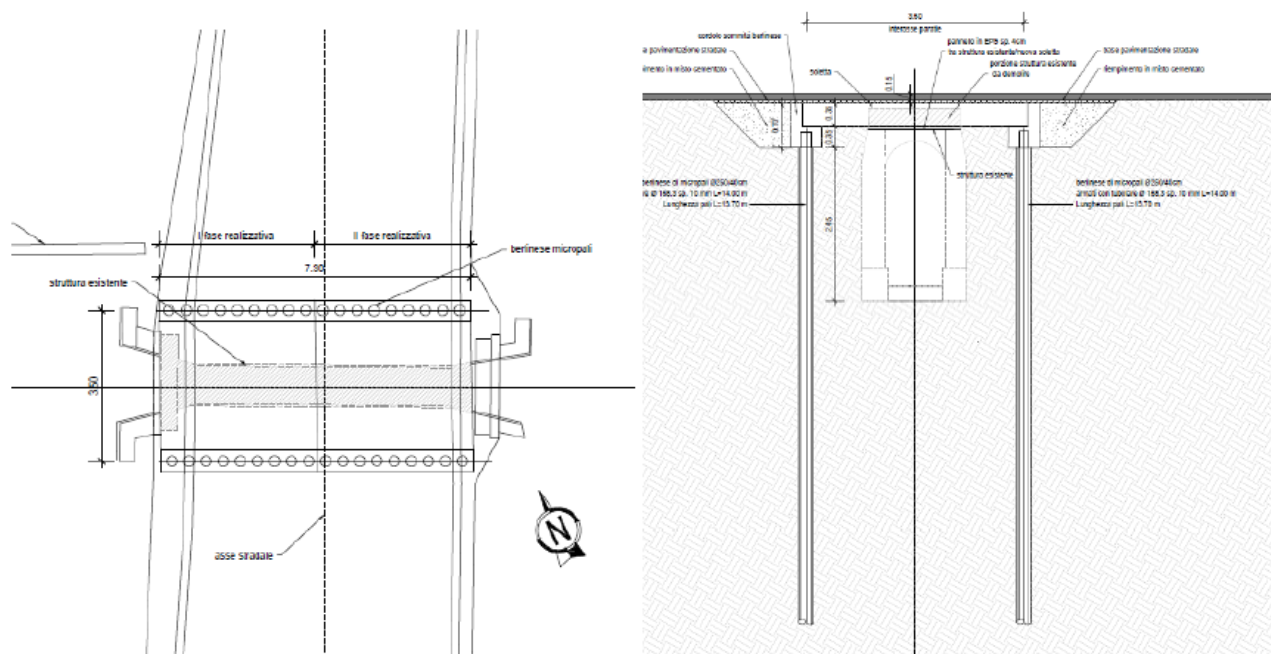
Planimetria e sezione di progetto attraversamento idraulico al km 48+050 della SS 14 (Fonte: All. 3 alla Lista di Controllo – Relazione Tecnica Generale)
